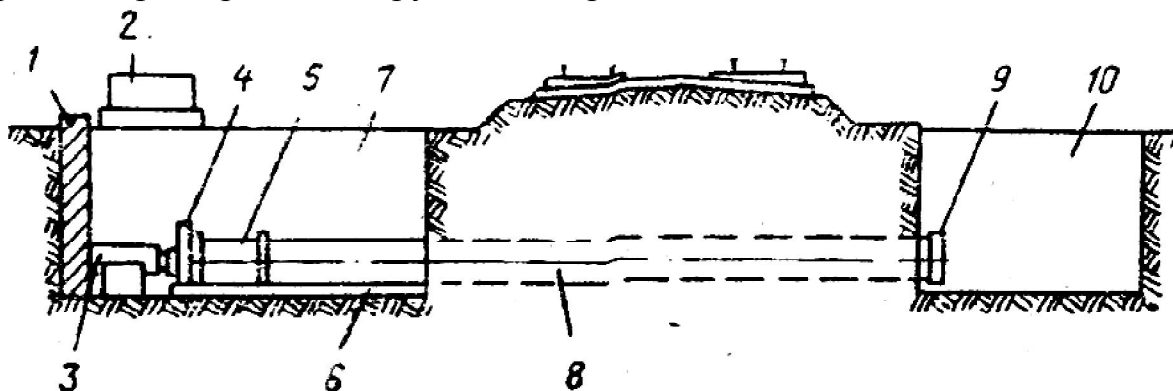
Прокладка труб способом продавливания (прокалывания): 1 – упорная стенка; 2 – насос высокого давления; 3 – домкратная установка; 4 – нажимная заглушка; 5 – нажимной патрубок; 6 – направляющая рама; 7 – рабочий котлован; 8 – прокладываемая труба (кожух); 9 – нож; 10 – приемный котлован
